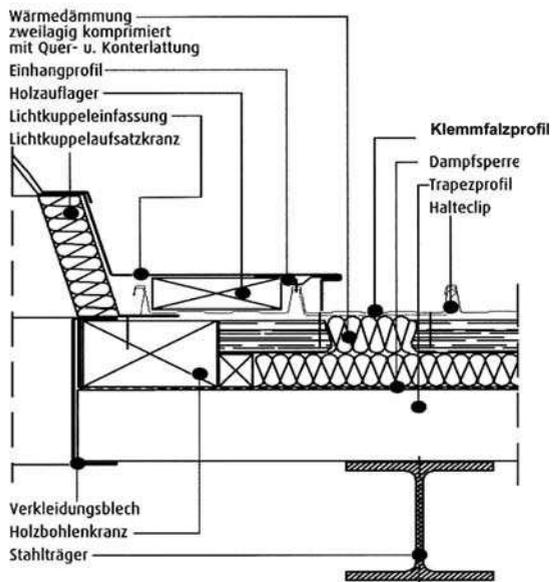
Querschnitt durch eine Ausrahmung für den Einbau in Klemmfalzprofile aus Stahl
